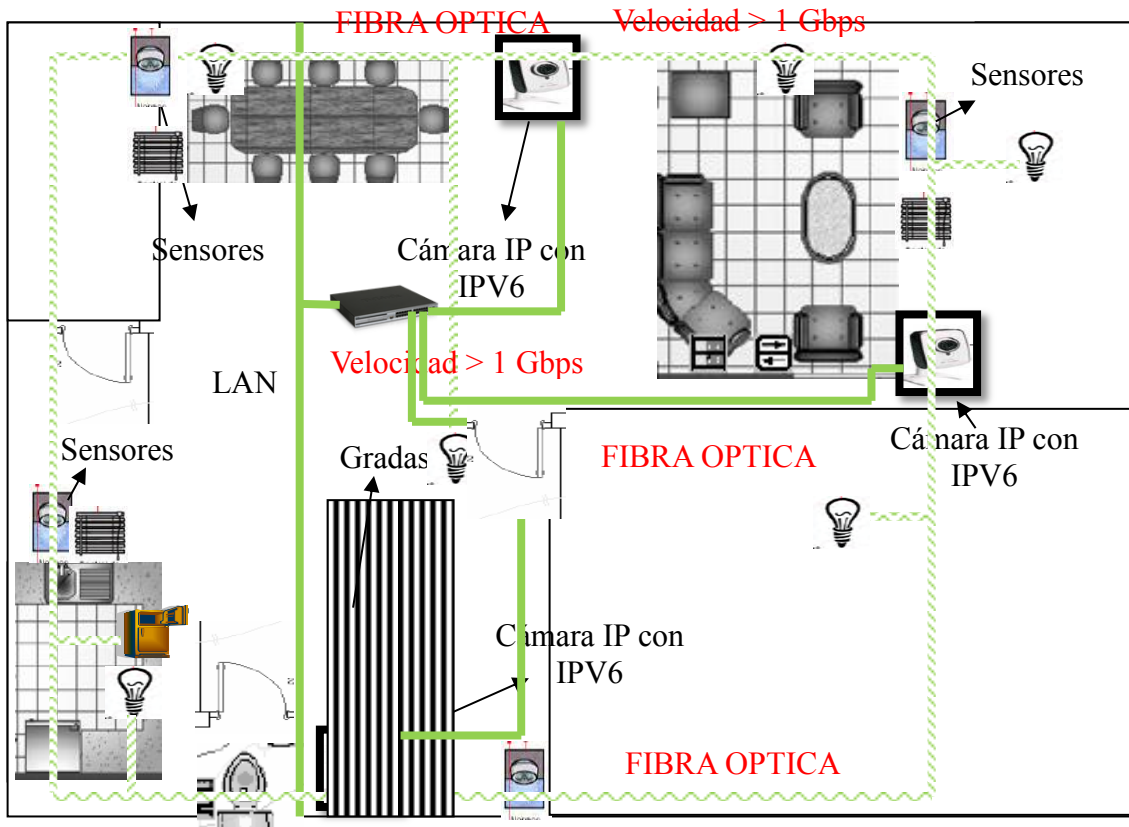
Red LAN propuesta Nro. 3 (Planta Baja).
